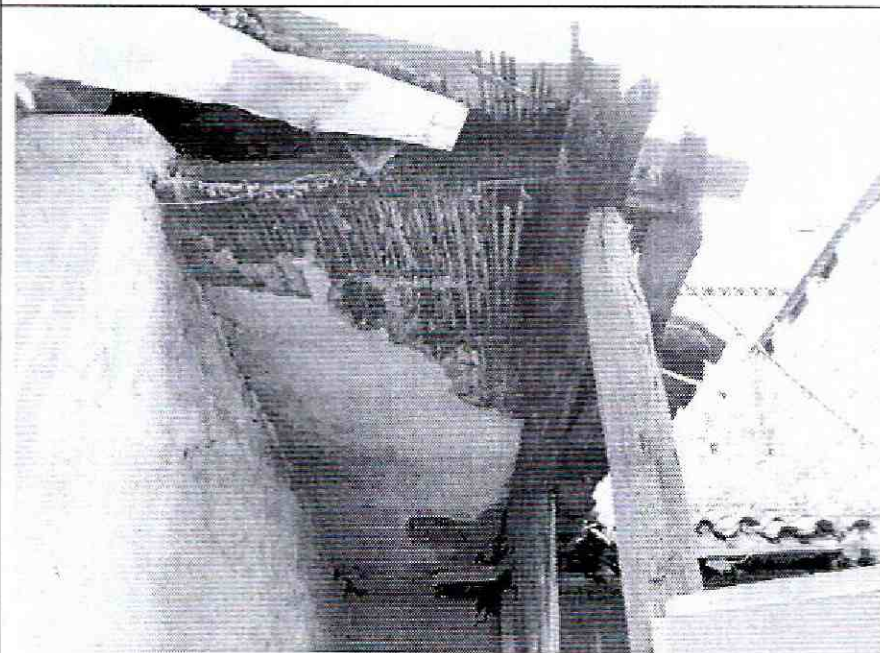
Daño en cielo raso y en elementos de la cubierta.
